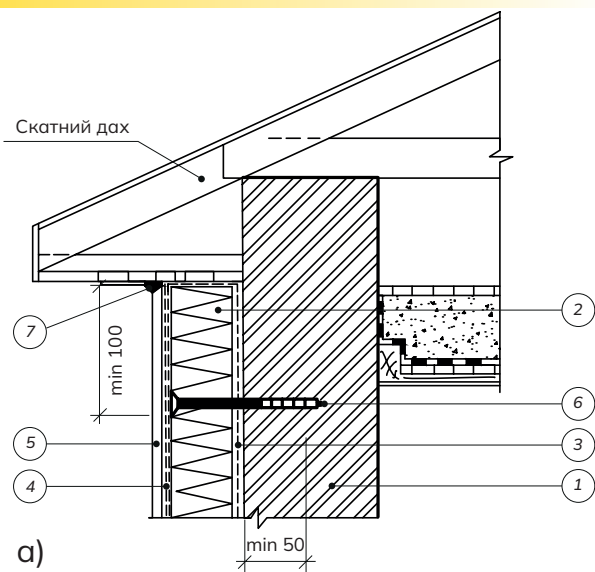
Влаштування теплоізоляції на останньому поверсі в будівлі зі скатним дахом
